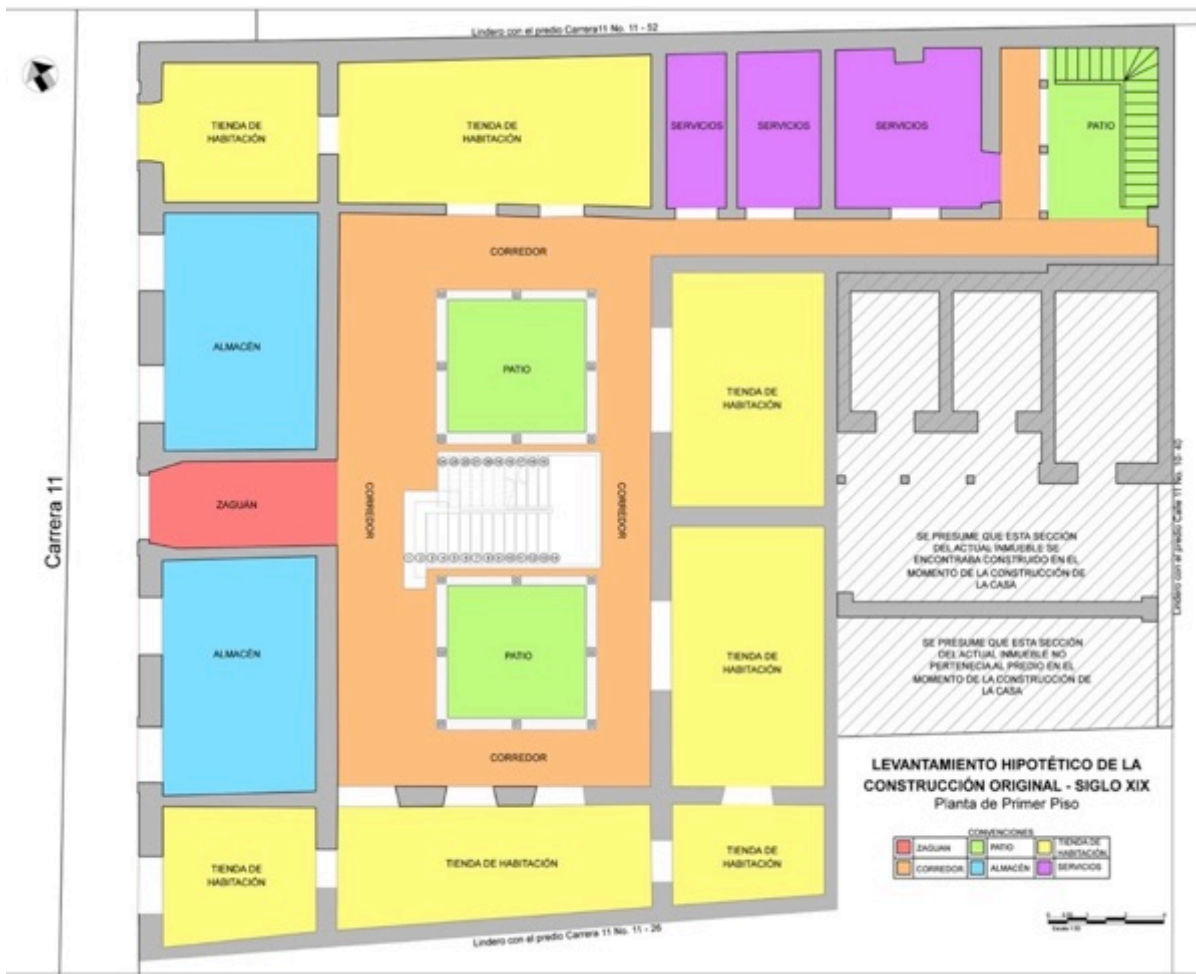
Planta de primer piso del levantamiento hipotético de la construcción original.
